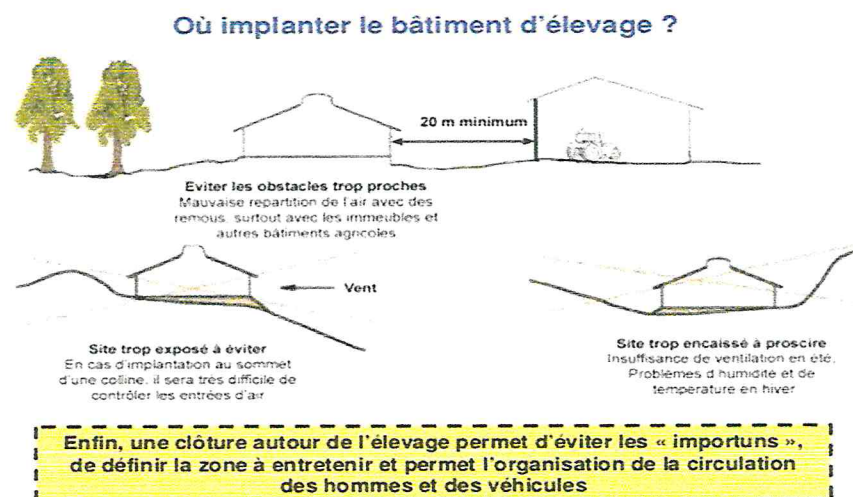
Implantation du bâtiment d'élevage. (Lebas, 2009).
